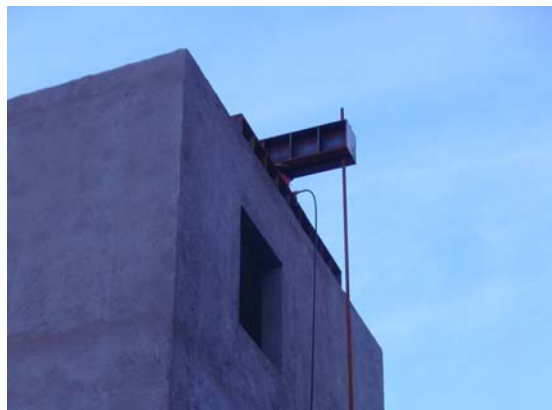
Collegamento dei tiranti verticali in sommità (tirante collegato ad una trave a doppio T disposta ortogonalmente alla parete corta, appoggiata al di sopra di un martinetto posizionato al di sopra di un'altra trave a doppio T parallela alla parete corta).
